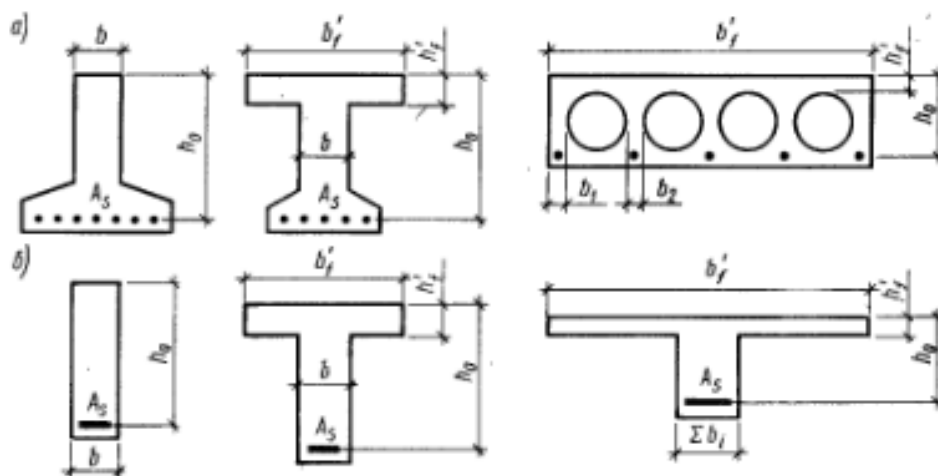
Фактические (а) и расчетные (б) сечения балок и плит
